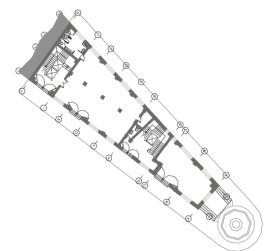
Planta edificio Turri. Fuente: Gallardo 2015.
